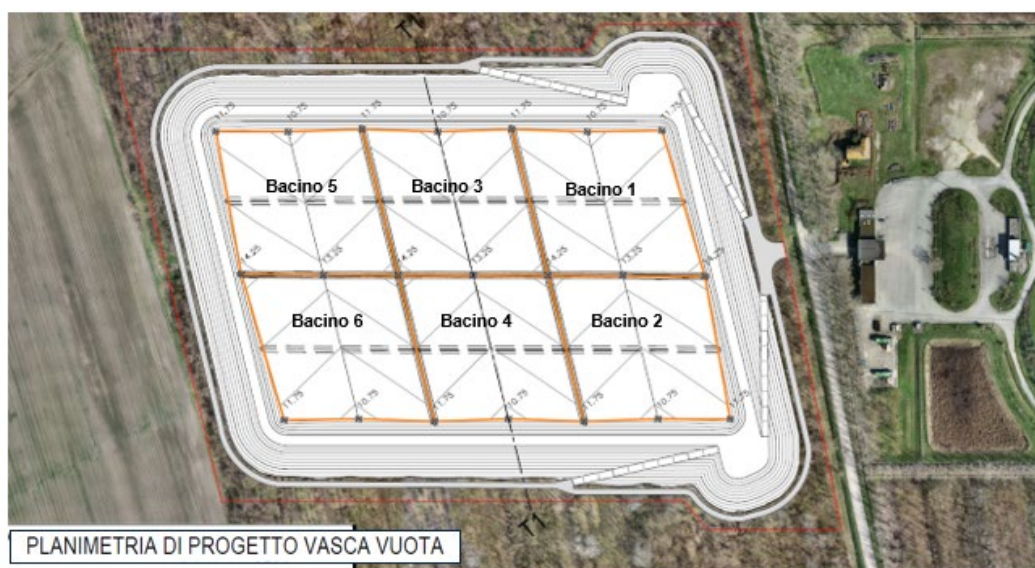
Planimetria generale dello stato di progetto, vasca vuota
